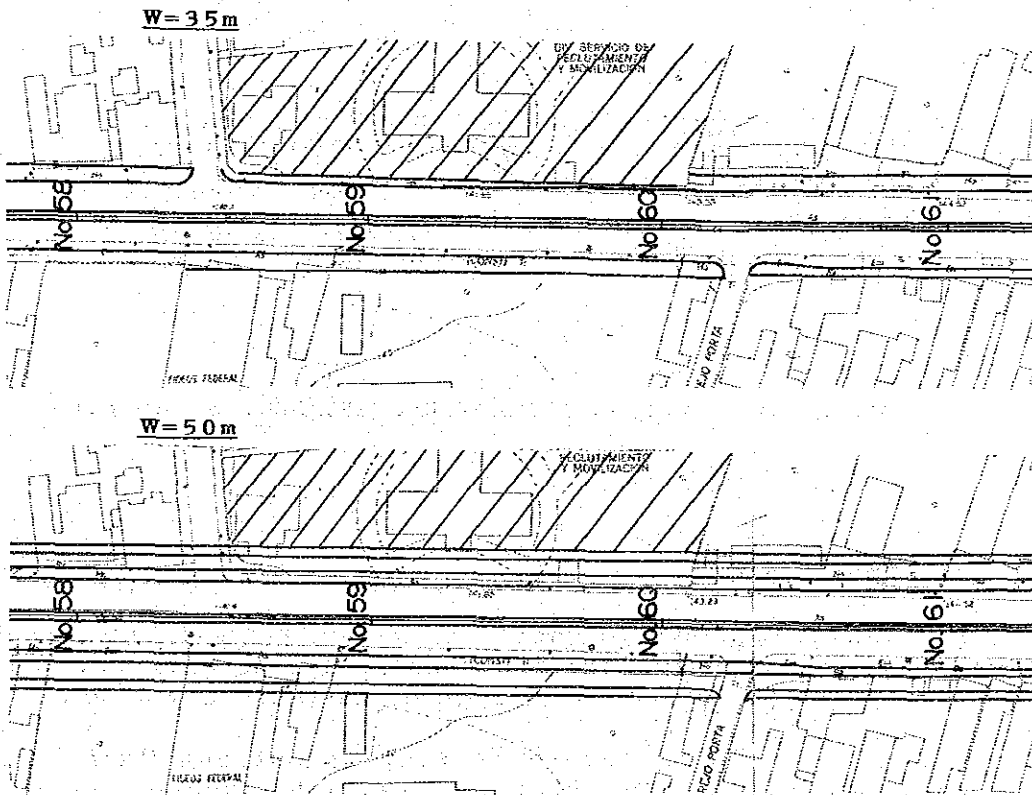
PLANO DE LA AV.E.AYALA (SECCION No. 59 + 10)
